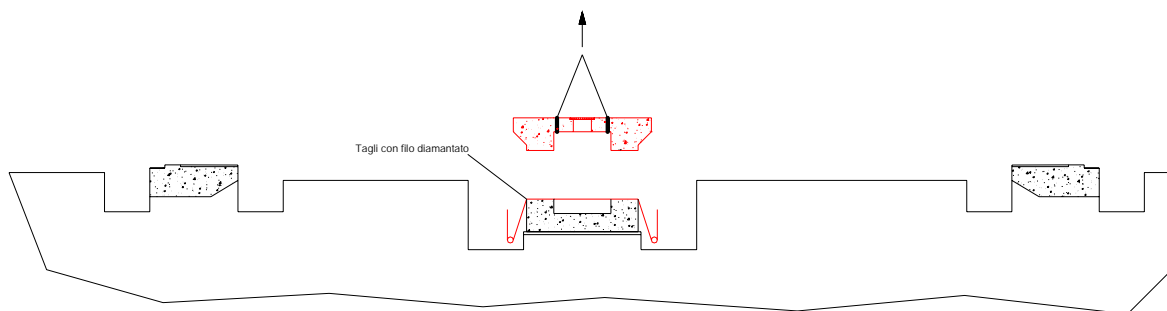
taglio e rimozione sezioni periferiche e struttura centrale fondazione
